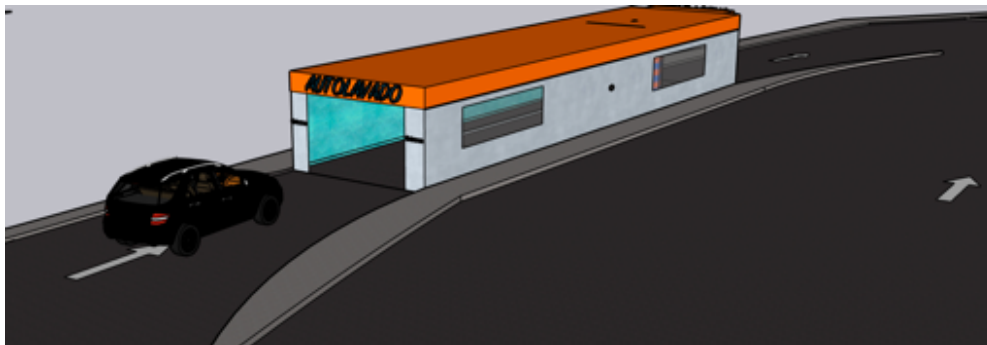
Implantación de túneles de autolavado. Elaboración propia con SketchUp.
